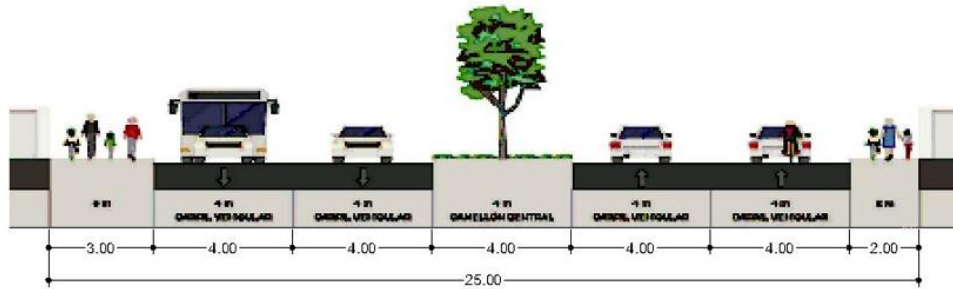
Av. De la Cantera y sus secciones viales. Fuente PDU 2040.
